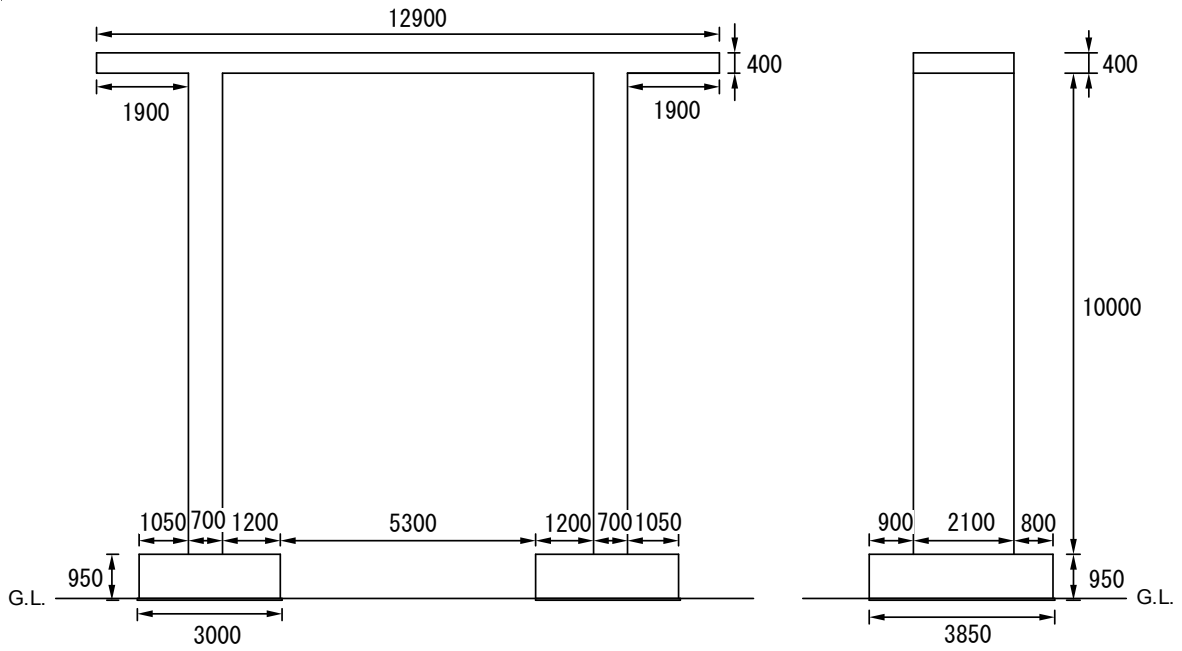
転倒したプラットフォーム立面図 (単位: mm)
